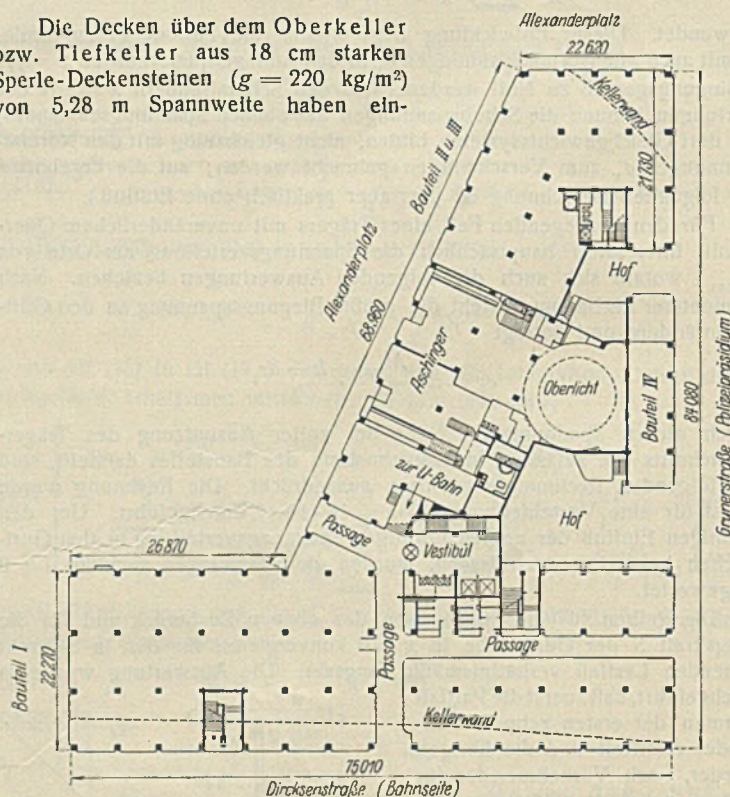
Erdgeschoßgrundriß des Hochhauses „Alexander“.
